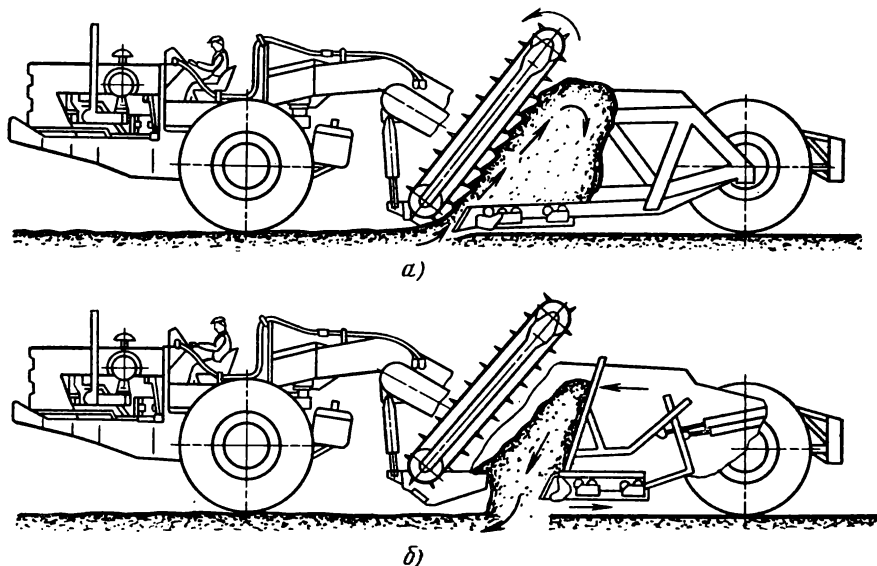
Схемы работы скрепера с элеваторной загрузкой: а — загрузка ковша; б — разгрузка ковша
